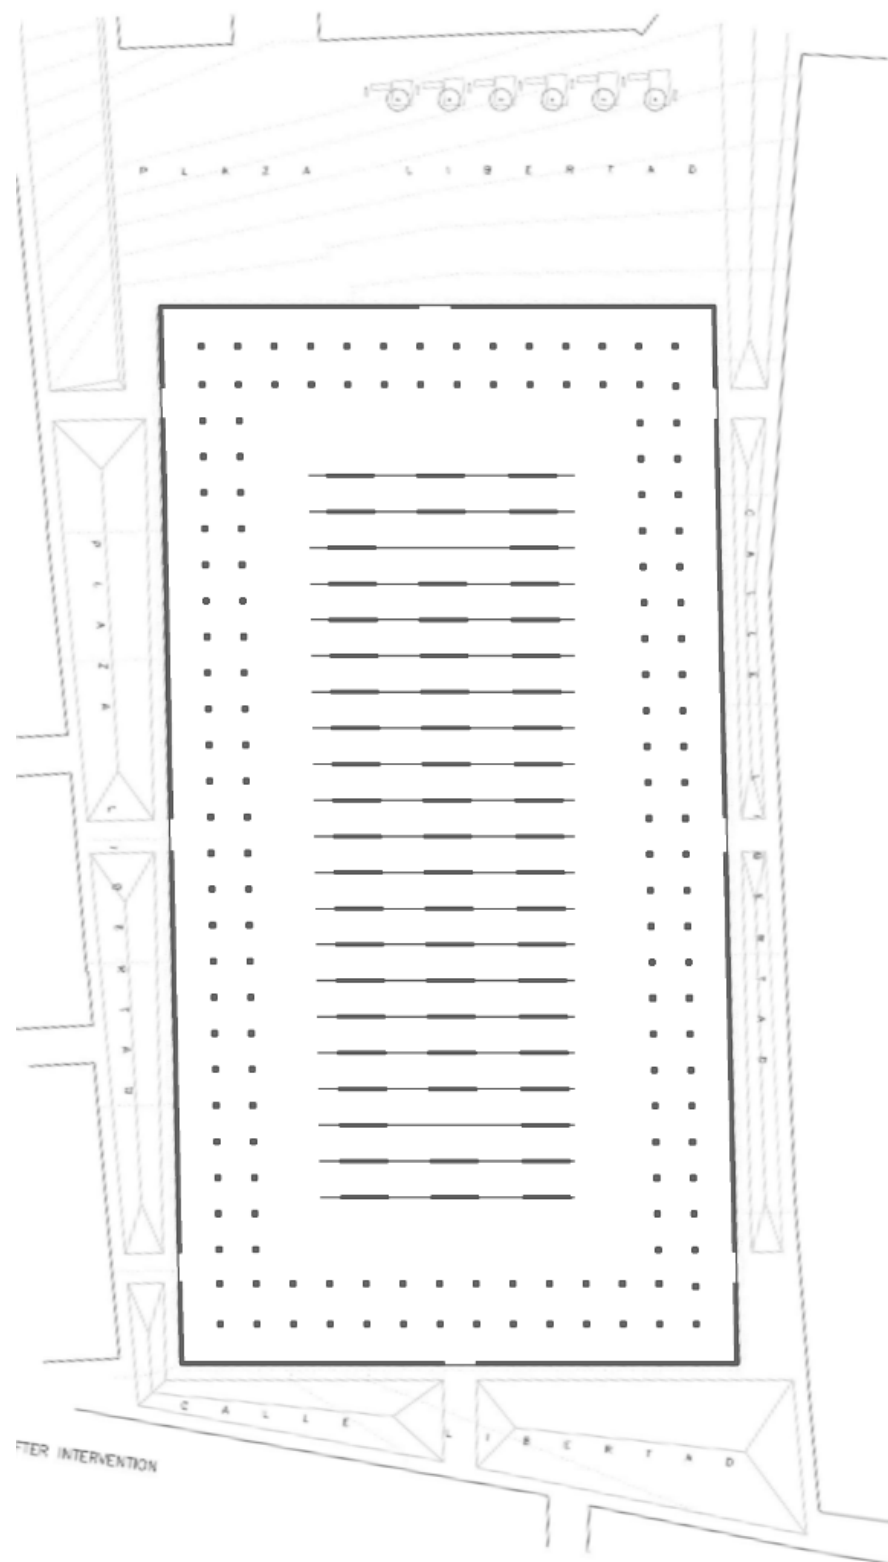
Planta estructural. Luces: 4m. Fuente: autor.
